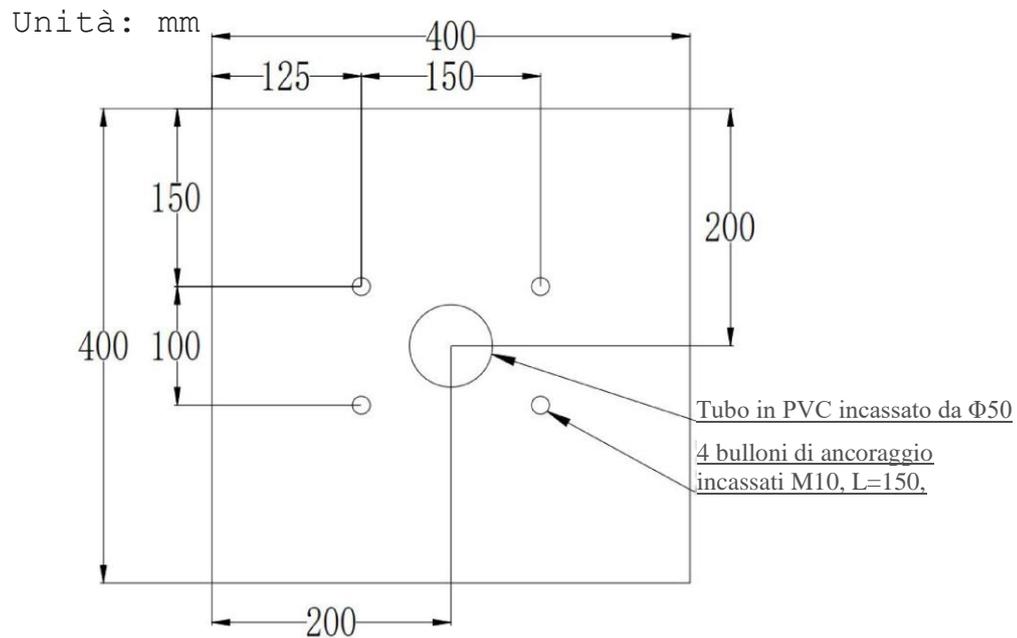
Disegno dall'alto della fondazione in calcestruzzo
